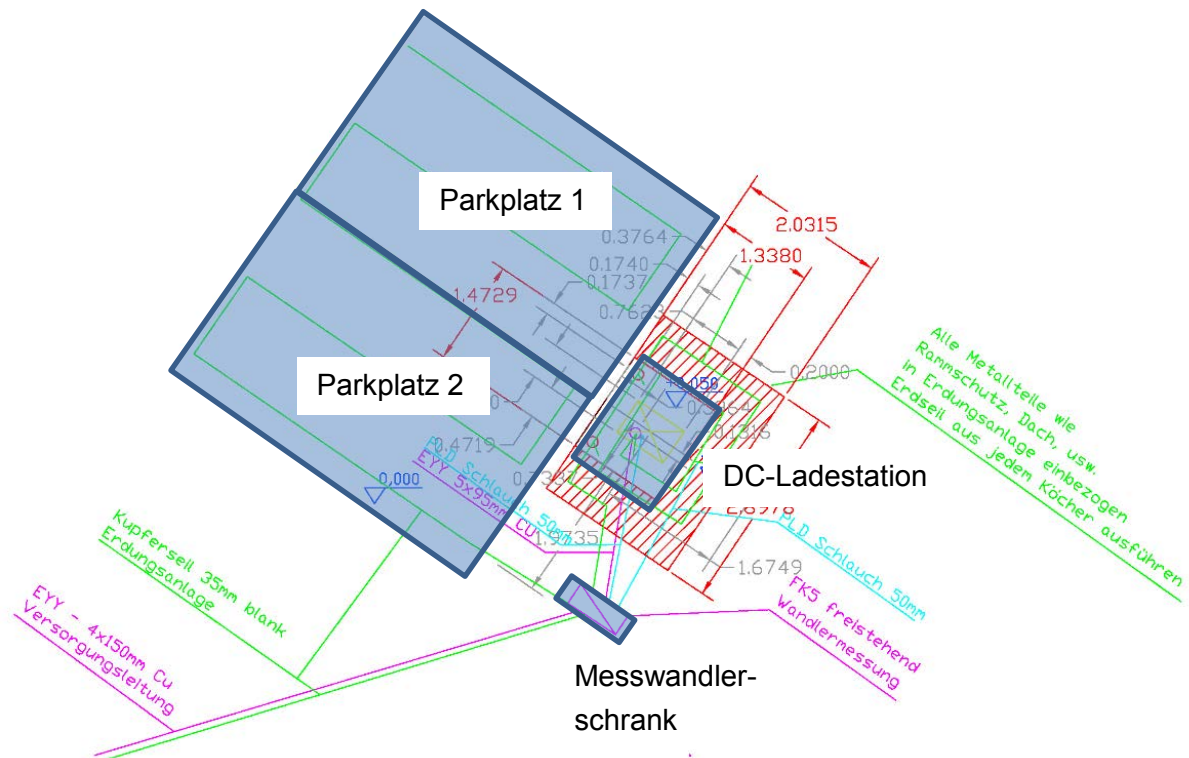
Grundriss (EVCS, Messwandlerschrank, Parkplätze, Zuleitungen) (vgl. [36])
